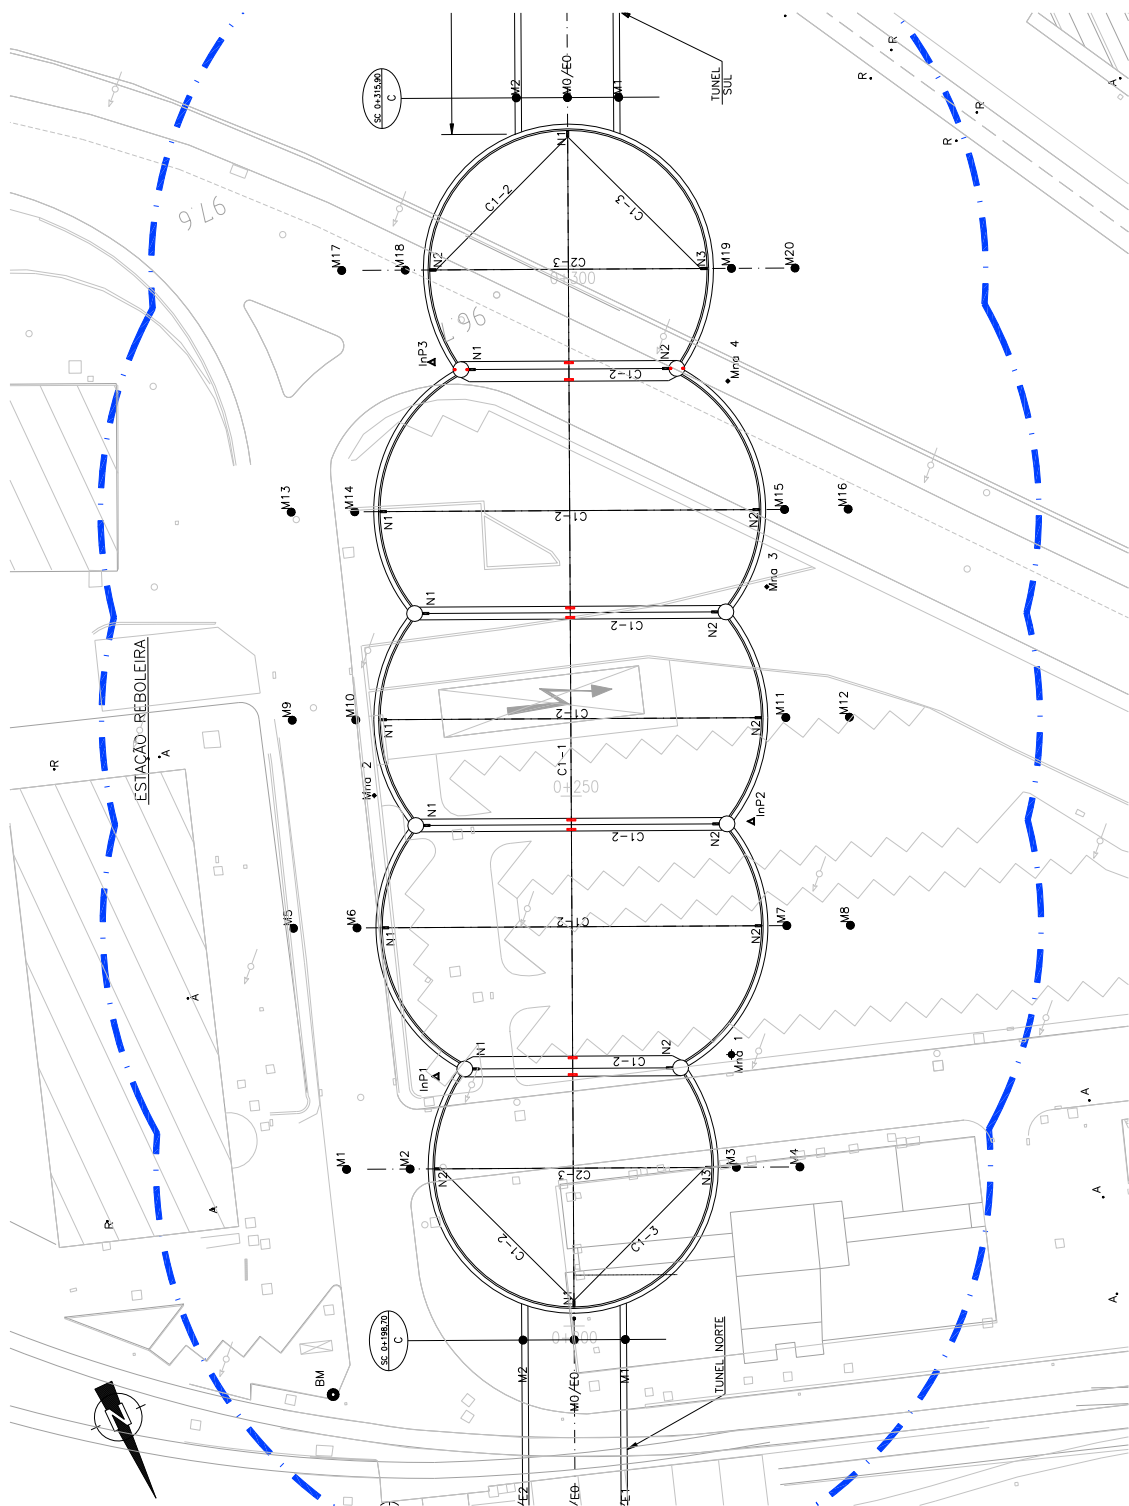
Instrumentação da Estação da Reboleira – Planta (CJC 2009).
